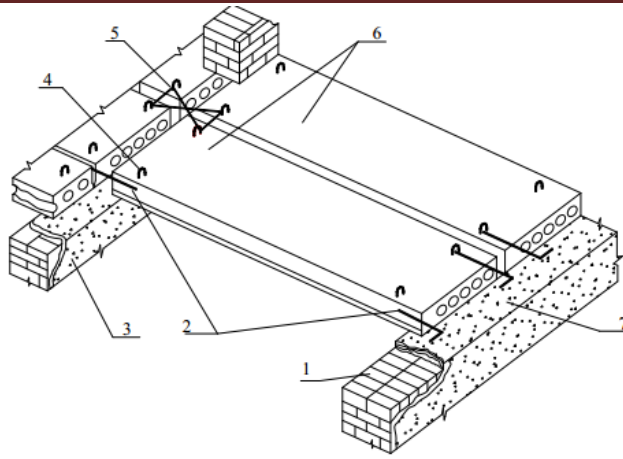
Міжповерхове перекриття: 1 – зовнішня стіна, 2 – анкери, 3 – внутрішня стіна, 4 – монтажні петлі, 5 – дротяна скрутка, 6 – залізобетонні плити, 7 – розчин
